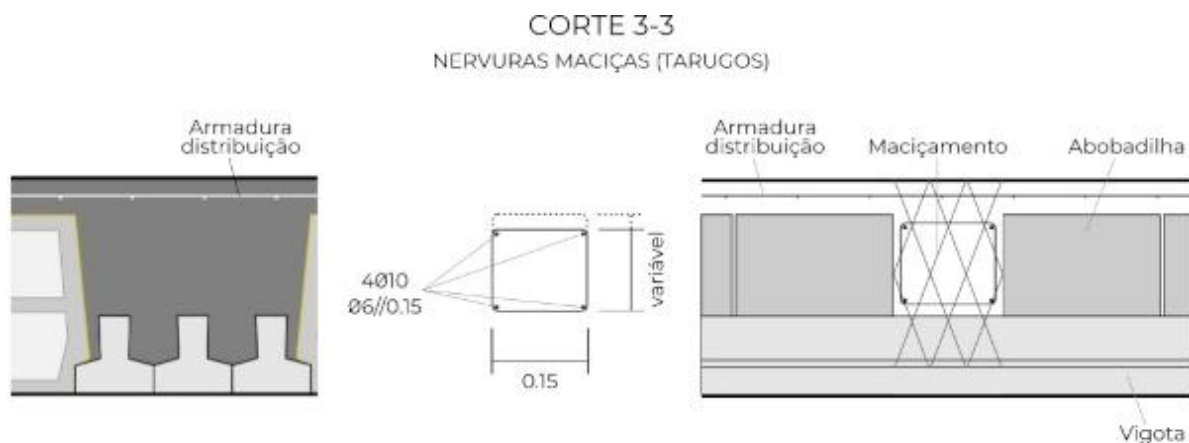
Nervuras transversais (Tarugos) em pavimentos com espessura total até 200 mm
